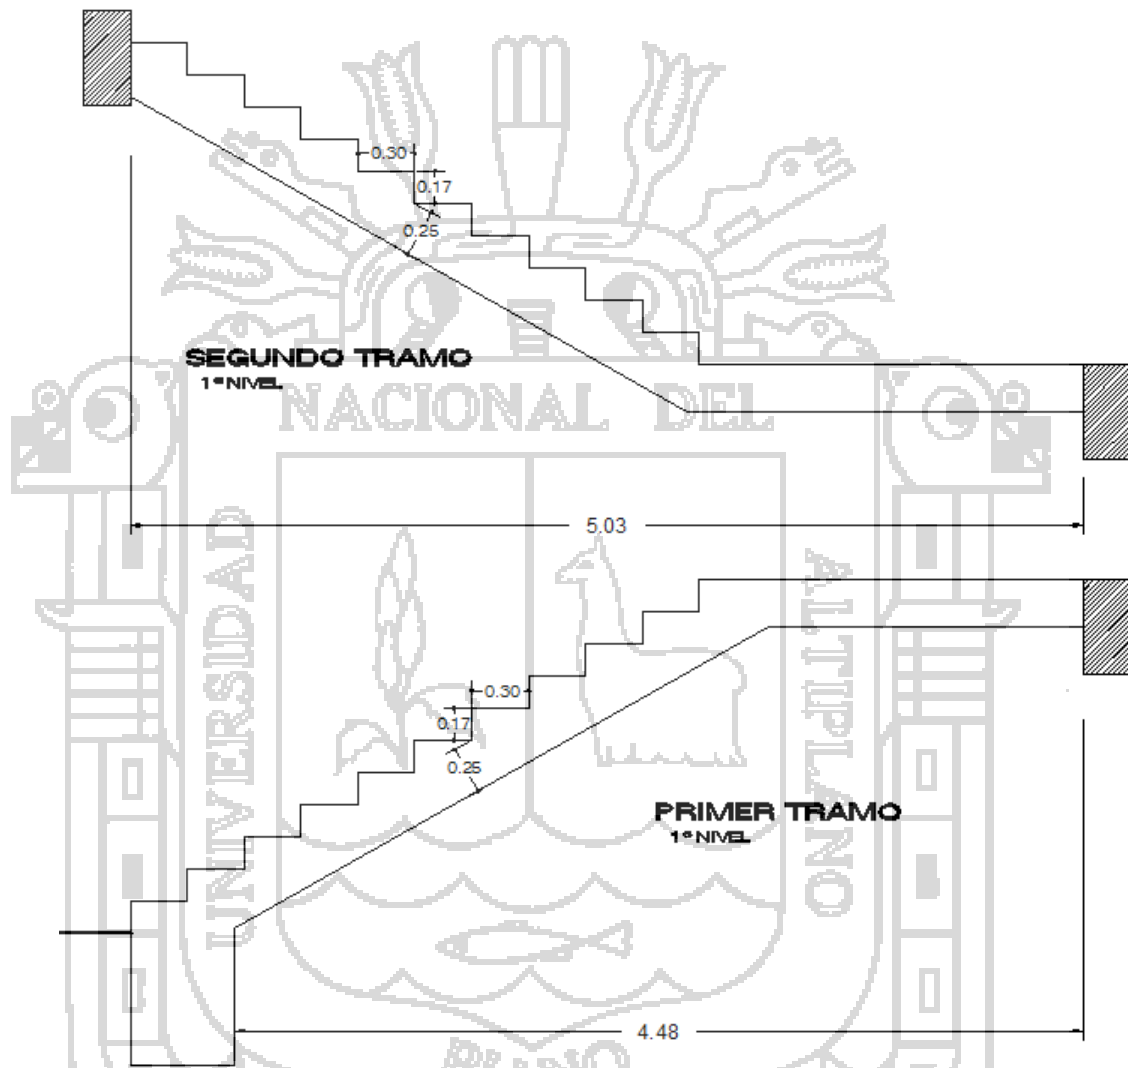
DETALLE DE ESCALERA DEL BLOQUE A
